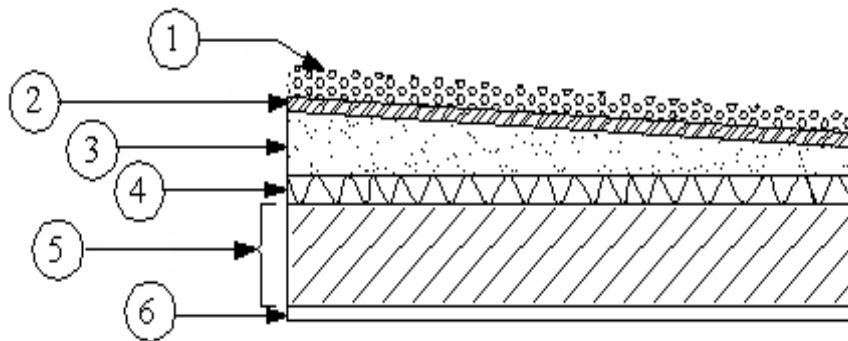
Coupe du plancher terrasse inaccessible (dalle pleine)
